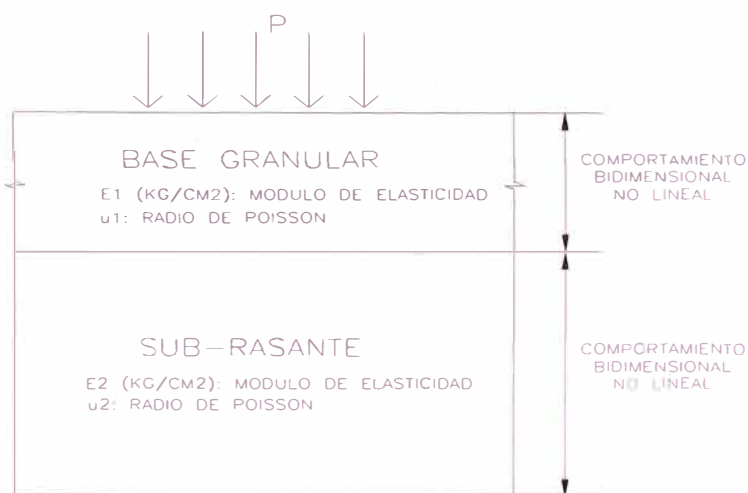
Modelo de pavimento de base finita y subrasante infinita.
